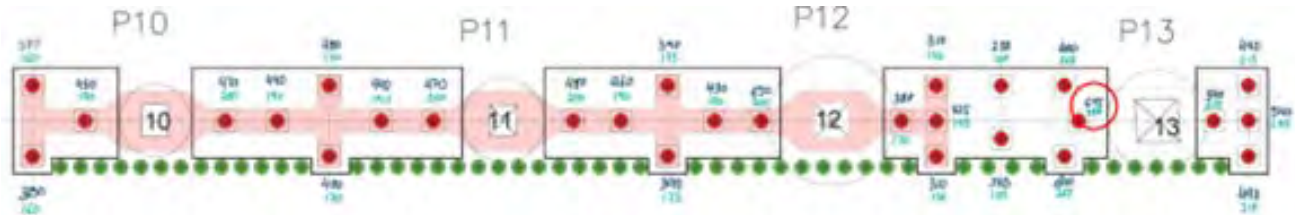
Planta alineación de pilares originales del estadio bajo grada este y su recalce con micropilotes. Procedente proyecto de ejecución.
